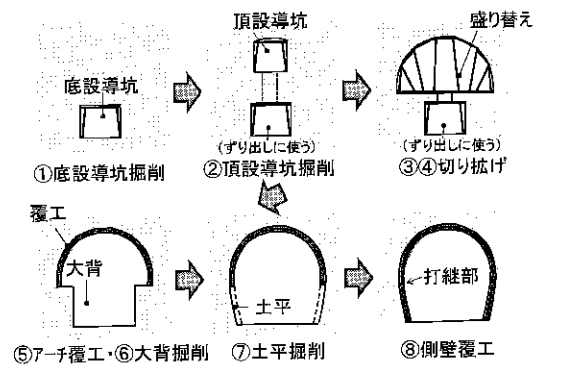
矢板工法の施工手順(新オーストリア式掘削工法の例)
